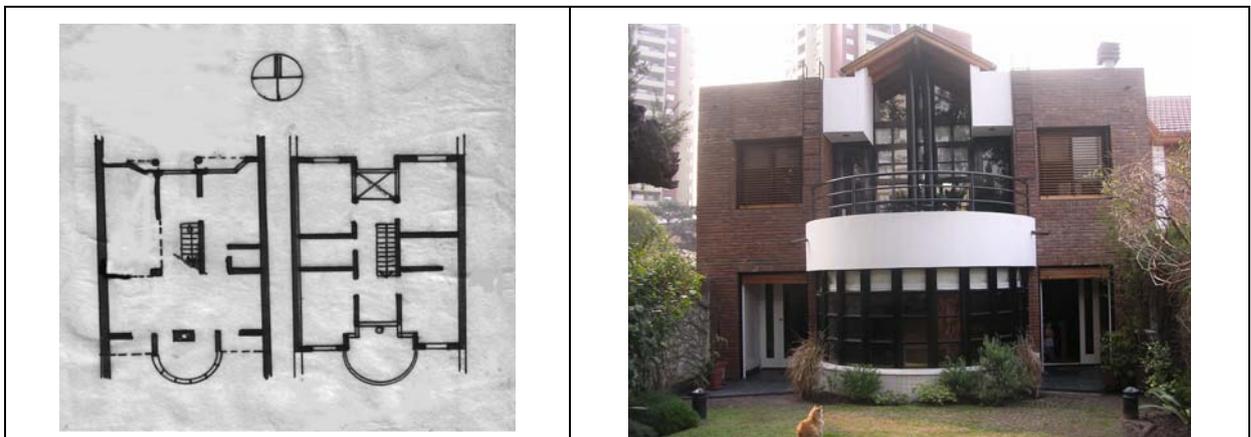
Vista Norte- Vivienda 1- Protección solar en verano
